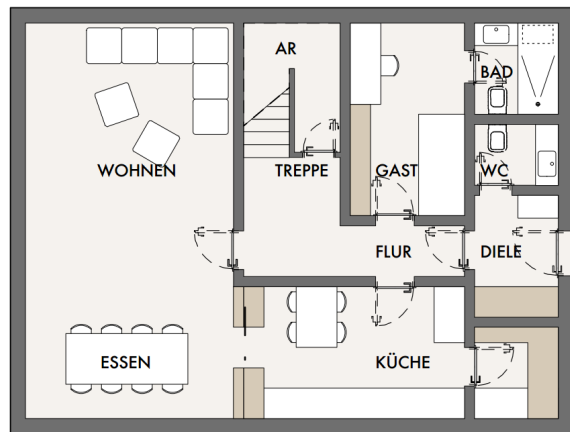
Geschlossener Grundriss - zweigeschossig
